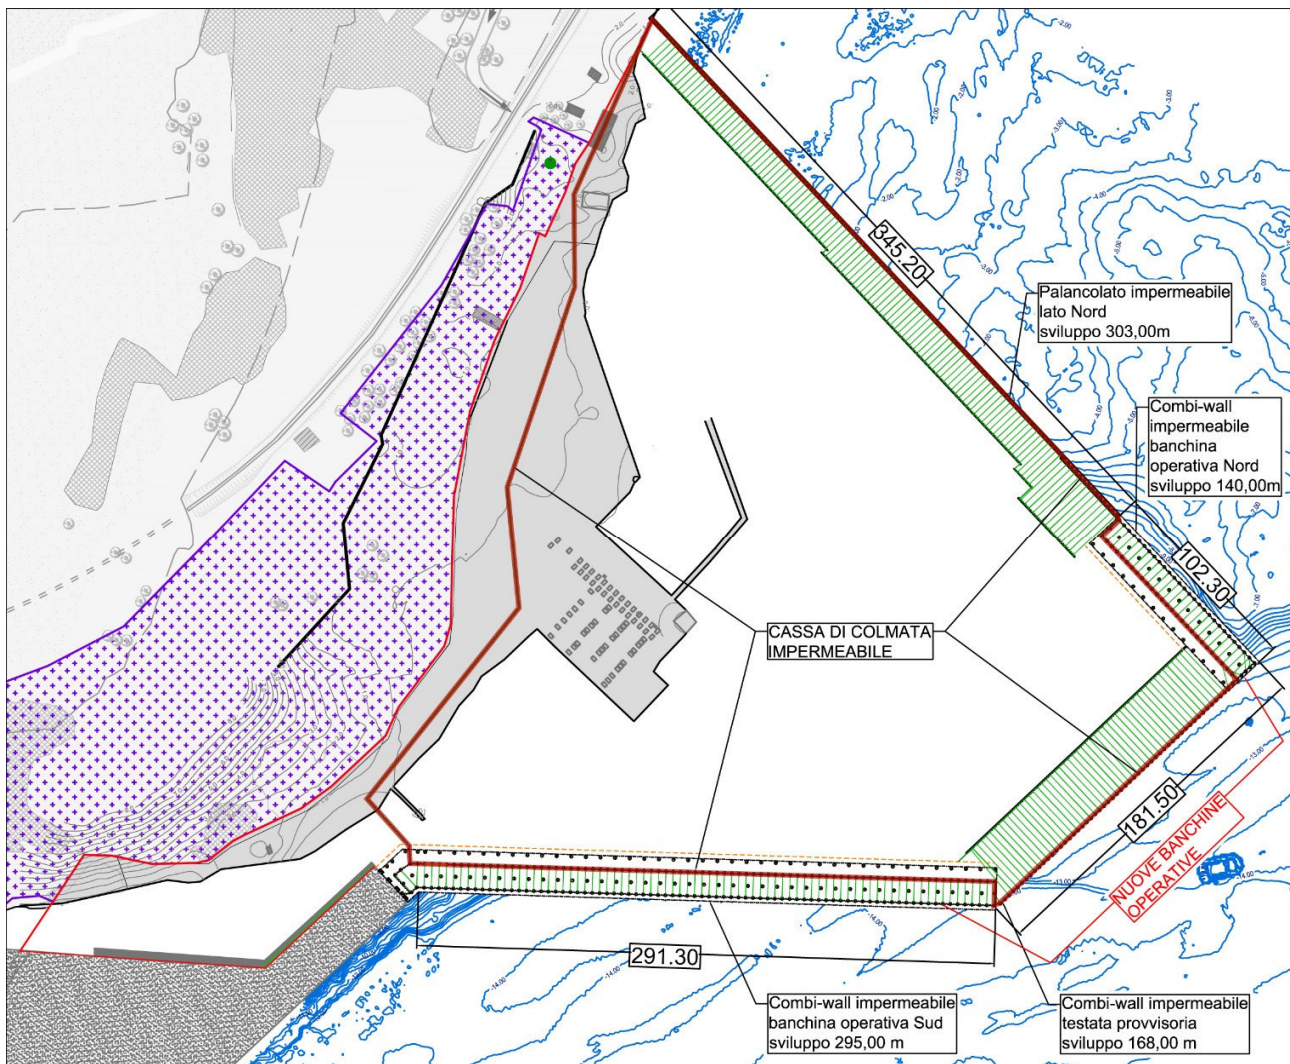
Planimetria progetto esecutivo di fusione ed integrazione tra il I° ed il II° stralcio
